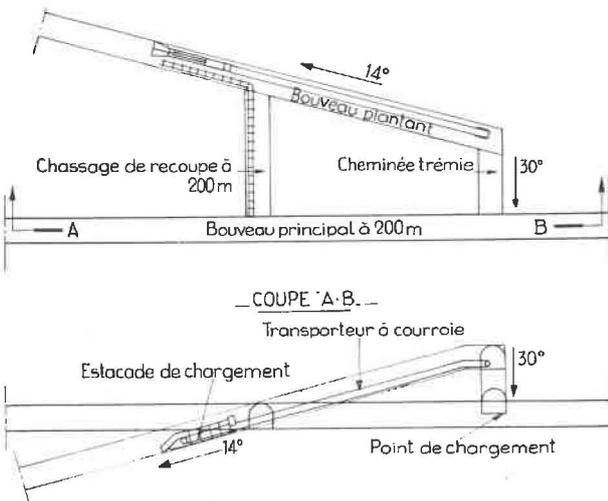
Chargement par scraper d'un bouveau plantant. Siège n° 6. Bouveau plantant sous 200m. Au-dessus : vue en plan. En dessous : coupe AB.
